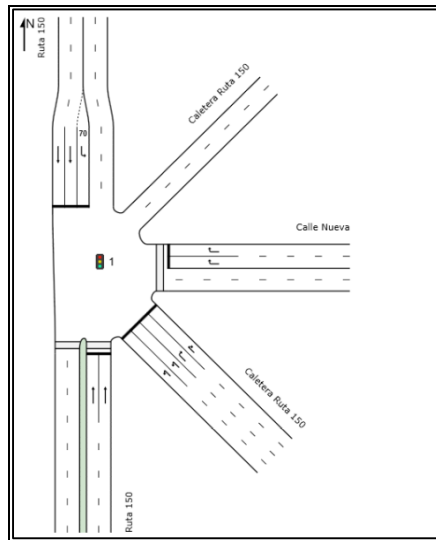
Layout Modelación Situación Con Proyecto intersección Outlet. Fuente: Sidra Intersection
